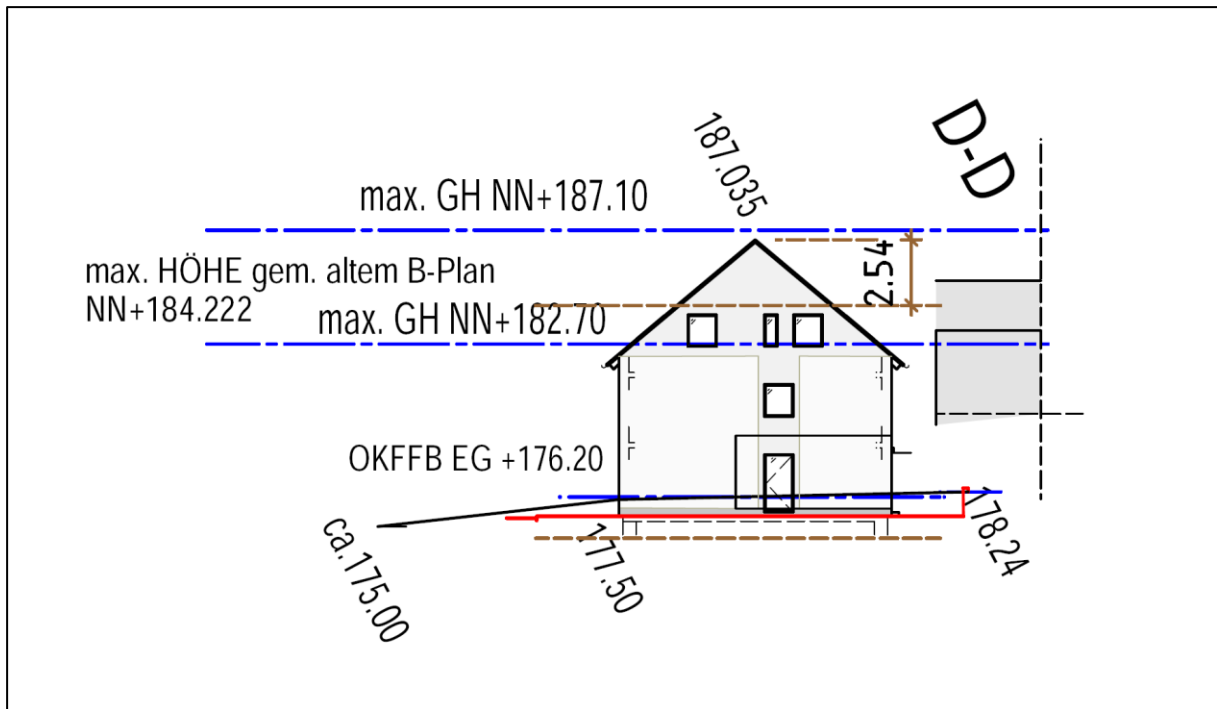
Schnitt D-D' zum Bestandsgebäude Kreuznacher Straße 12 (Flur 4, Flurstück 63)
